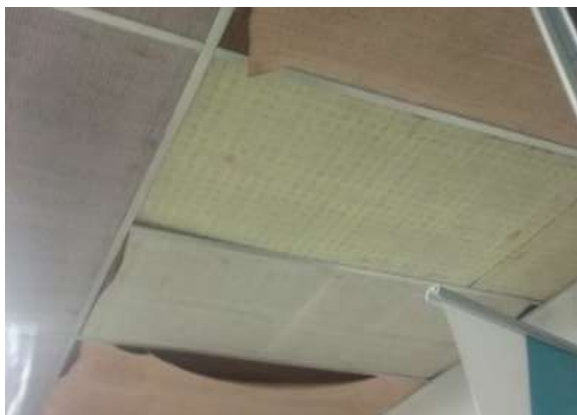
Evidencia de periferia de Drywall en mal estado
